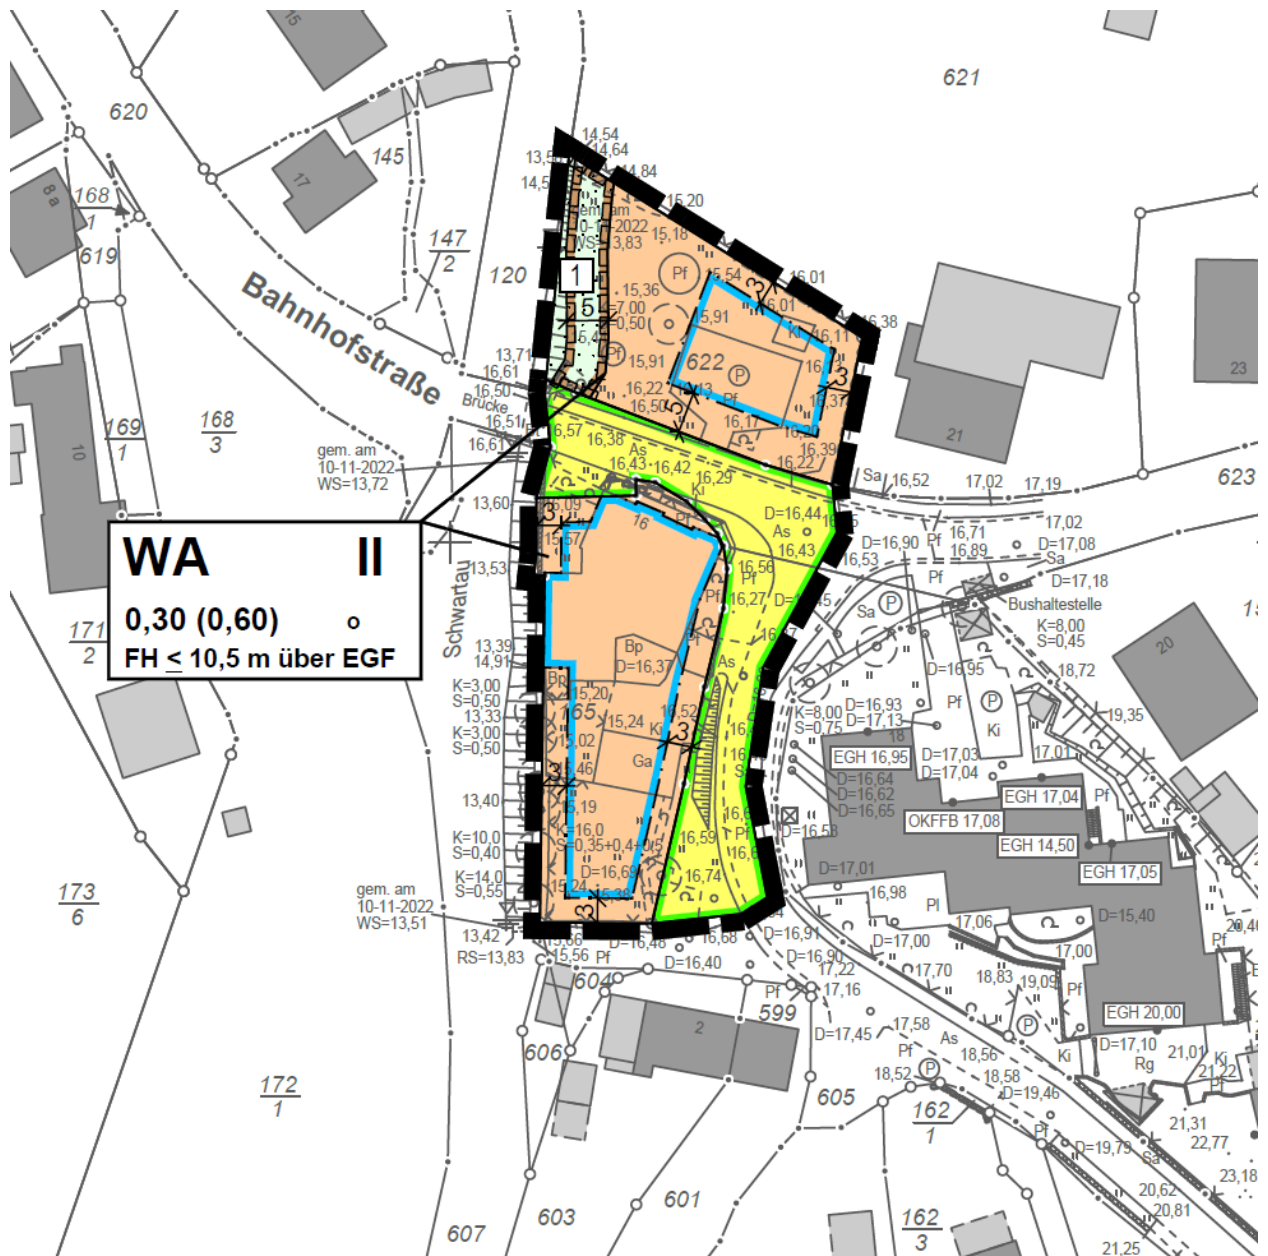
Planzeichnung - Bebauungsplan Nr. 17 – Sch –, 2. Änderung, der Gemeinde Scharbeutz, Stand Mai 2023
